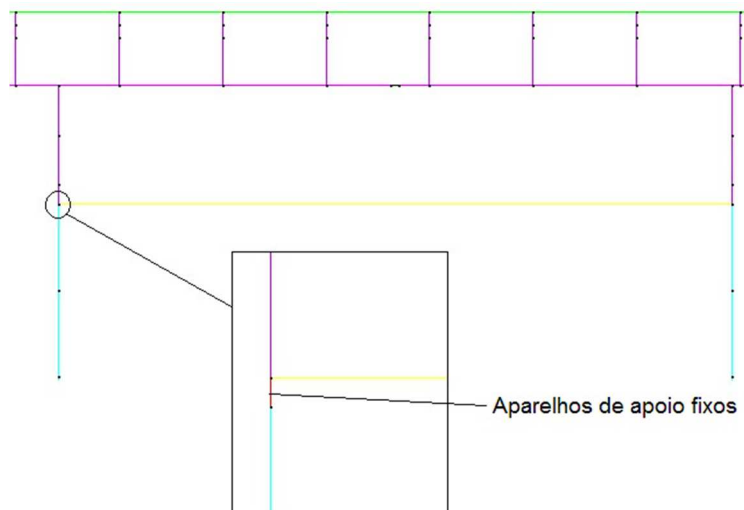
Pormenor da modelação dos aparelhos de apoio fixos sobre os pilares-estaca.
